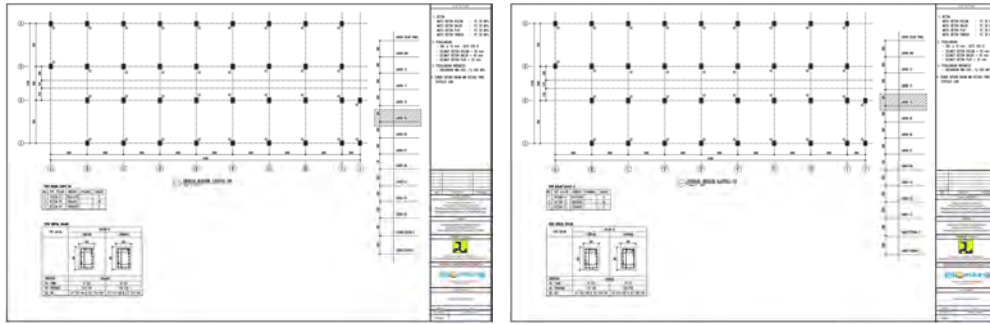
7 Detail struktur kolom lantai 3 dan 4
